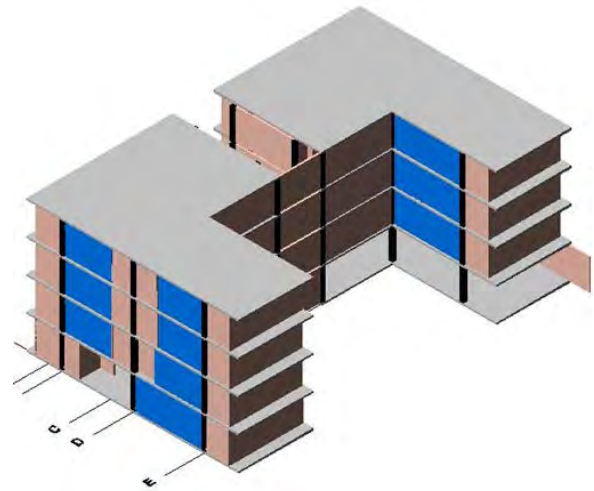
Vista del patio y del interior de la estructura, nivel PB.
